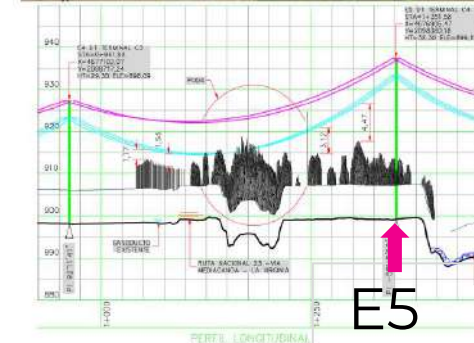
Planta - Perfil vano entre torres E4 y E5 de la línea de conexión a la subestación La Virginia 220kV
